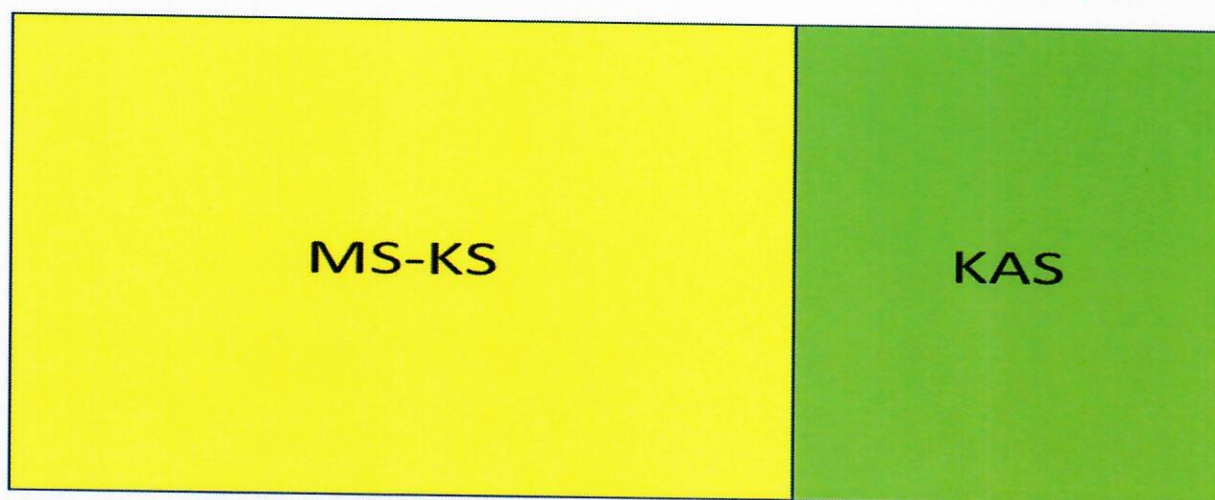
фрагмент фасадной стены (стенд) с зонированием по нанесению штукатурных составов.
